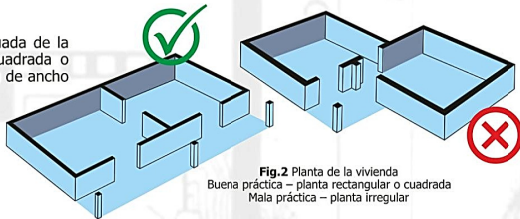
Planta de la vivienda Buena práctica - planta rectangular o cuadrada Mala práctica - planta irregular
